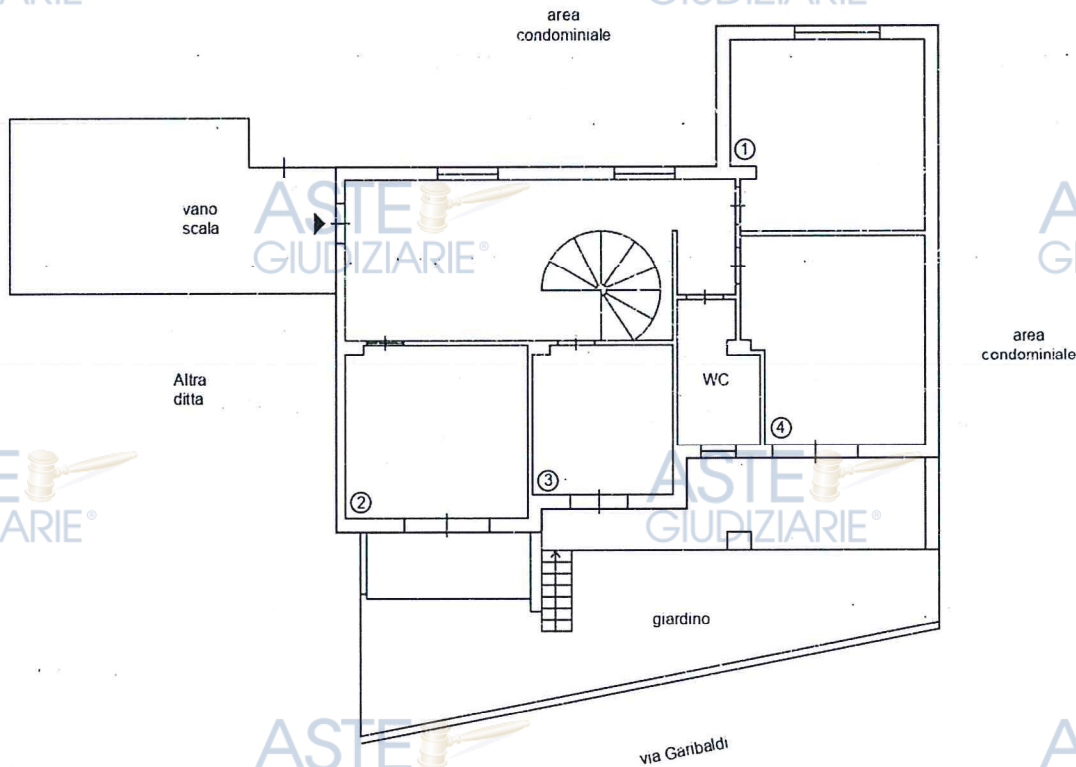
Planimetria stato di fatto appartamento piano rialzato.
